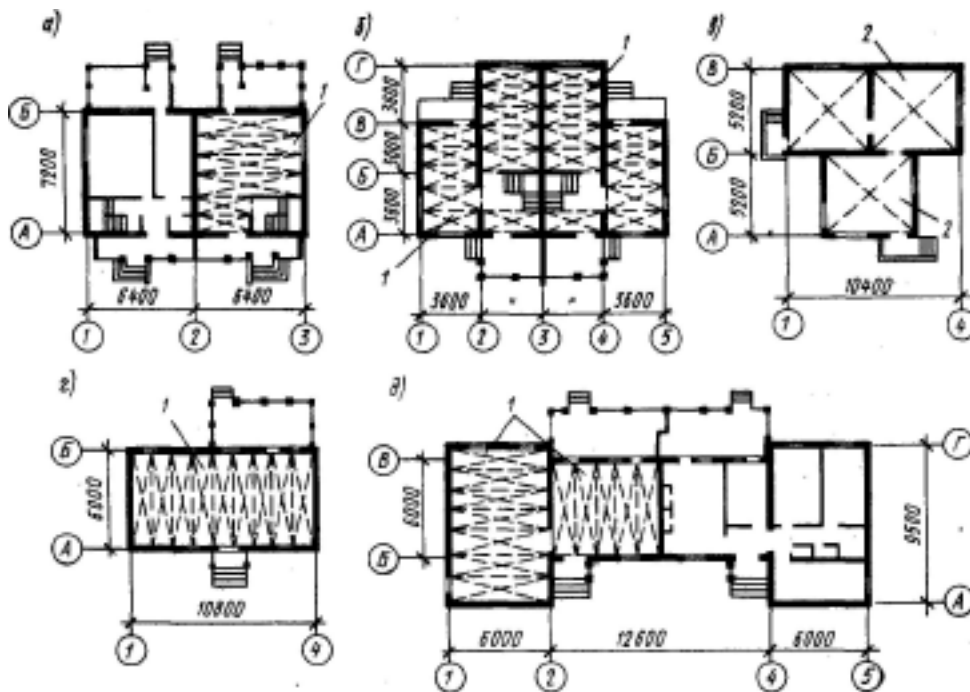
Планы конструктивных схем стеновых остовов малоэтажных зданий: а — с поперечными несущими стенами и большим шагом; б — то же, с малым шагом; в — коробчатый остов; г — с продольными несущими стенами; д — с несущими стенами в двух направлениях; 1 — балочный или плитный настил перекрытия; 2 — настил перекрытия на комнату с опиранием по всему периметру
